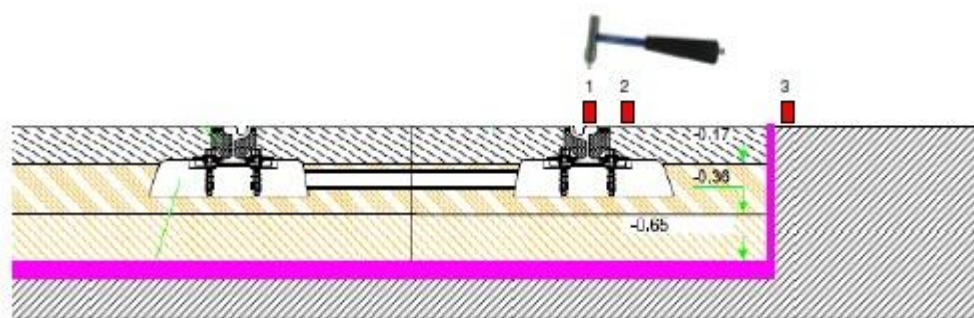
Exemple d'une mesure des vibrations sur une dalle flottante
